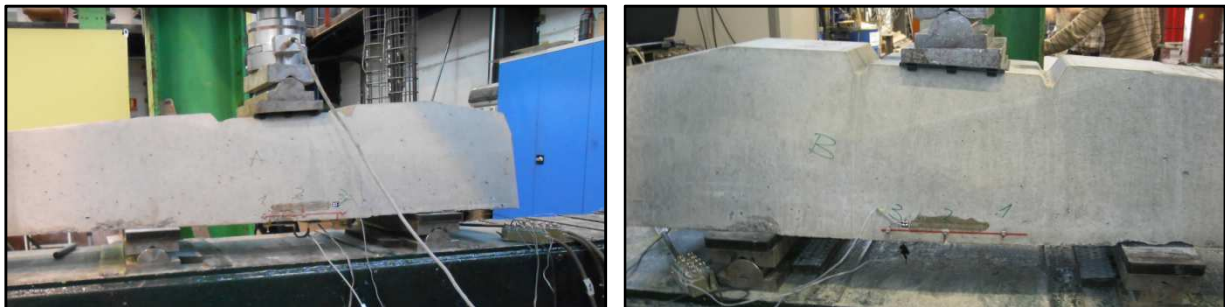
Fotografías del ensayo a flexión positiva en sección bajo carril; a) Traviesa ensayada, b) Detalle de la colocación de la galga en la superficie del hormigón
